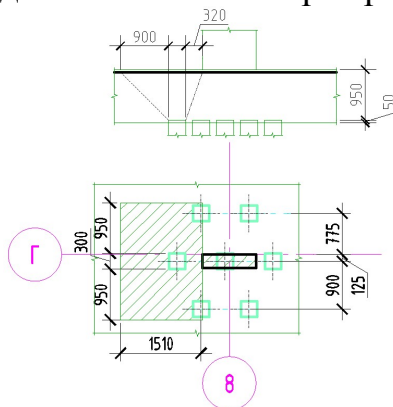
Схема к расчету плитного фундамента на продавливание
